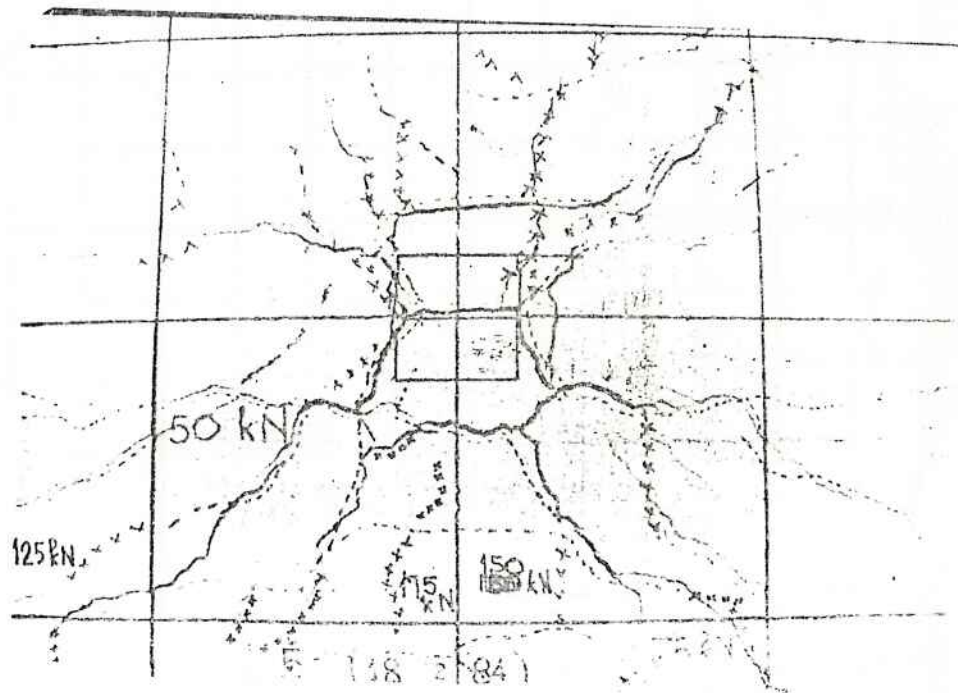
FISSURAÇÃO FINAL DA LAJE L 5
